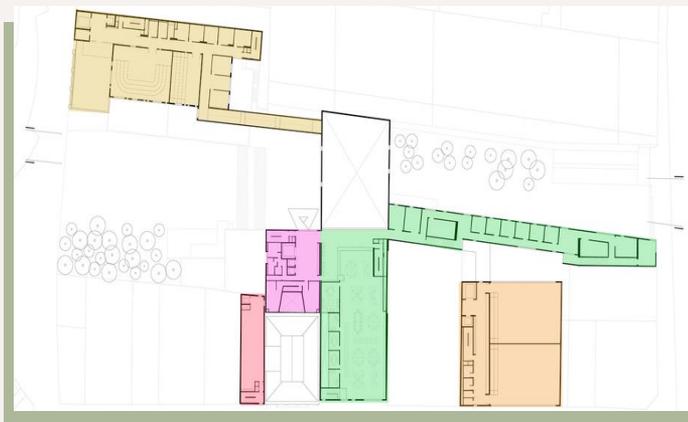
PLANTA TIPO DA PRAÇA DAS ARTES
